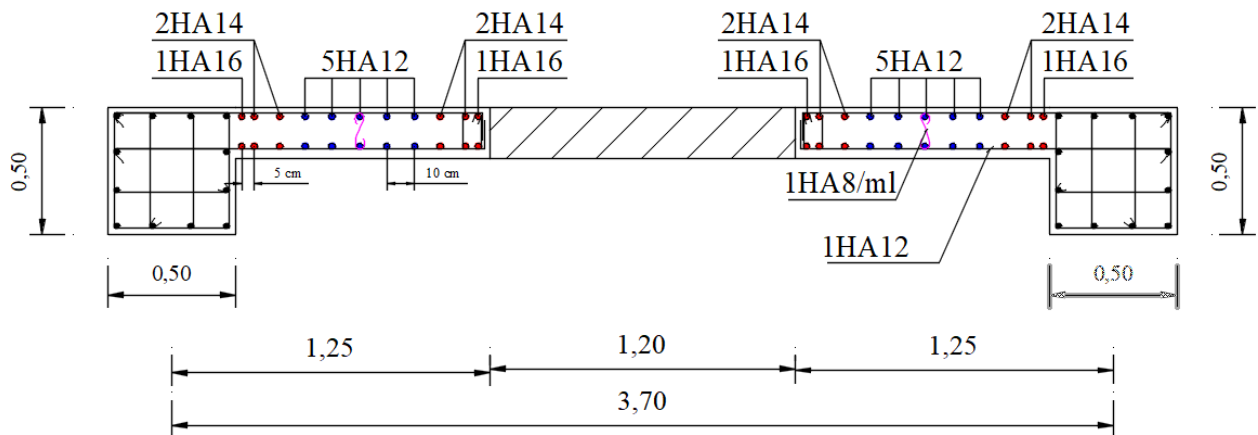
Schéma de ferrailage du trumeau VL2.
